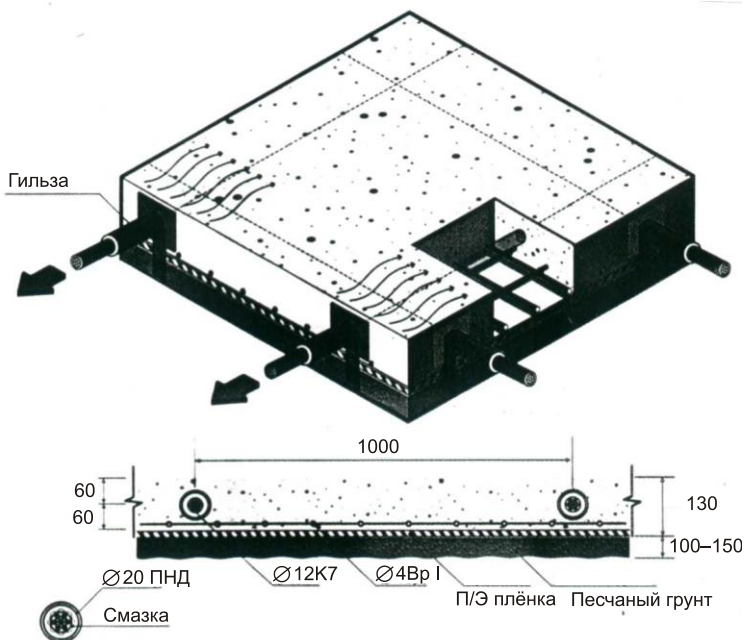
Железобетонная плита для устройства основания пола на слабых и промороженных грунтах
